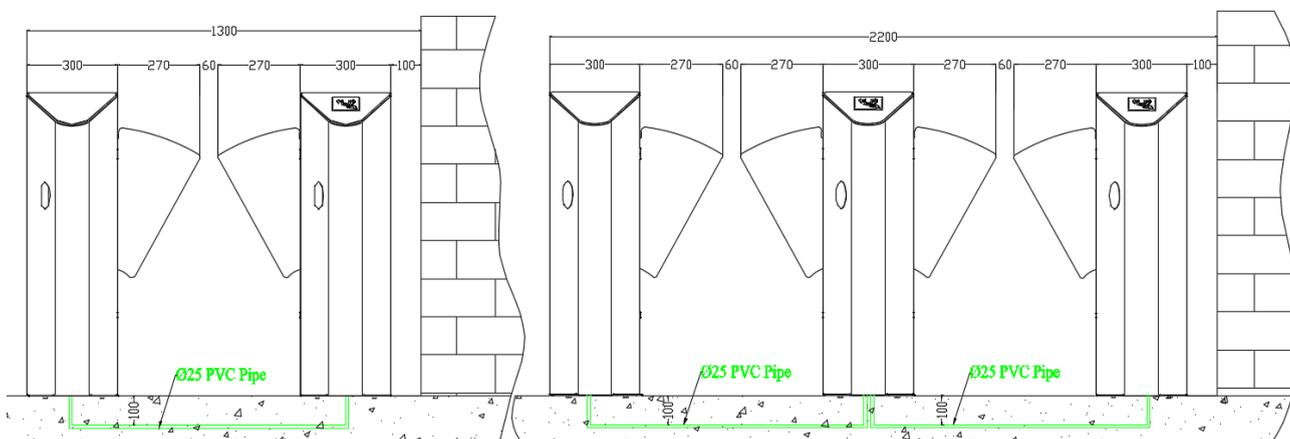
A Passagem Única e Passagem Dupla com FBL4000 Pro
